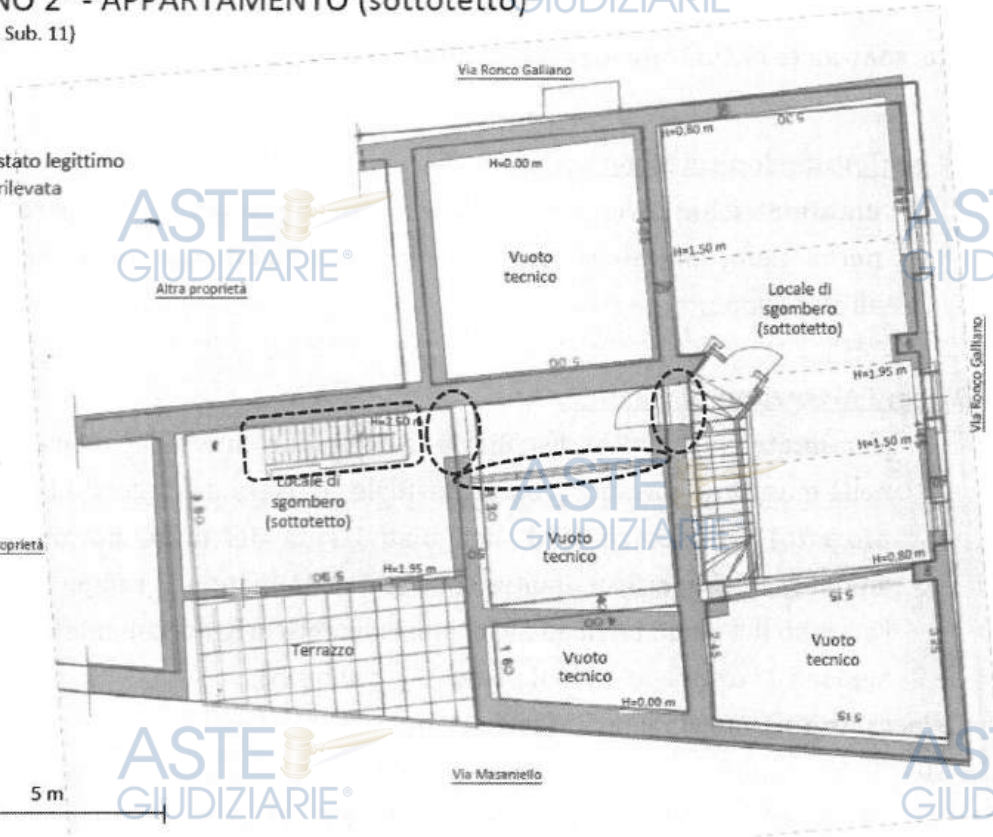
Sovrapposizione stato reale dei luoghi e progetto autorizzato - Planimetria abitazione - piano 2° (sottotetto)
